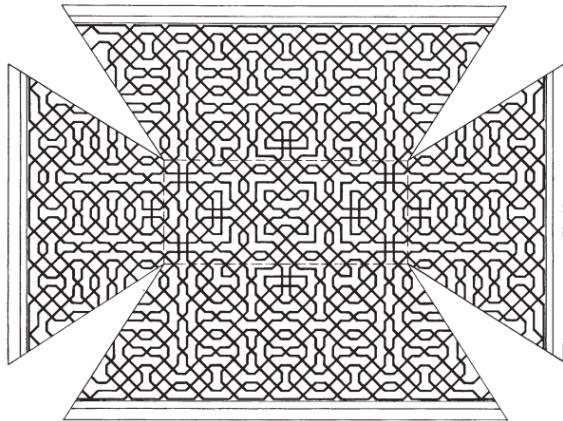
مسقط أفقي لسقف مصلى قصر البرطل
